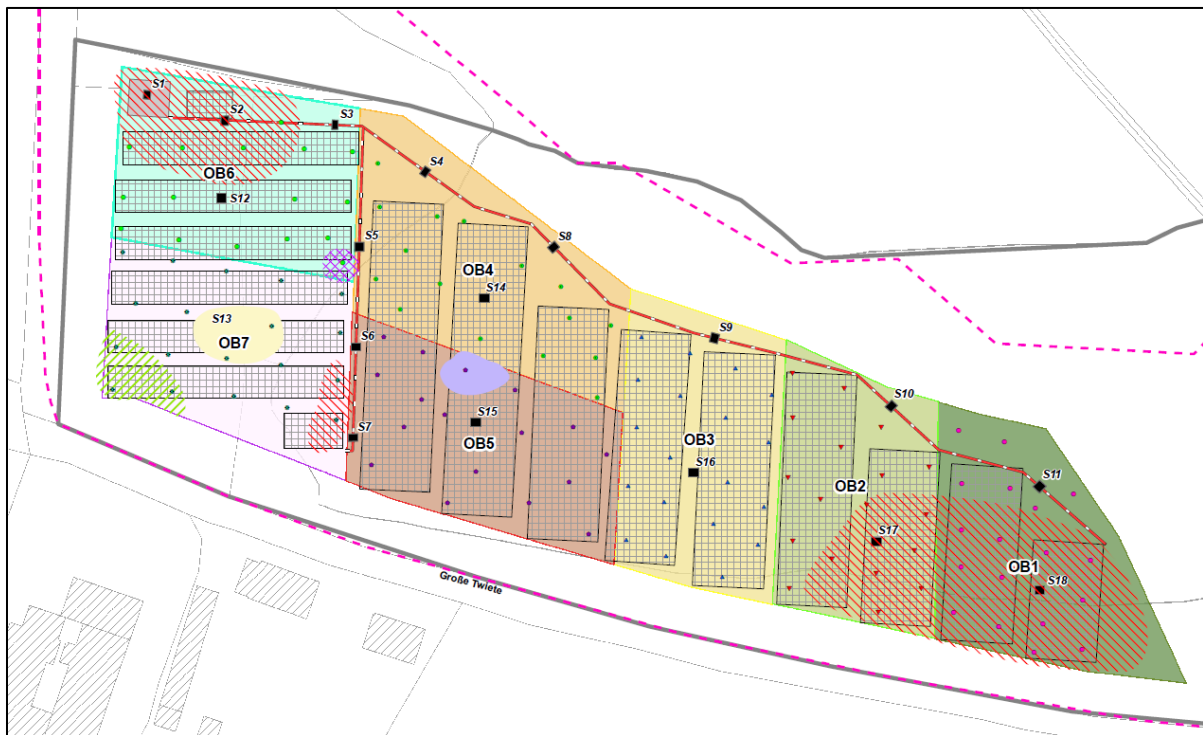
Lageplan Bodenprobennahme, Anlage 4 des Deponiegutachtens, I. Ratajczak
